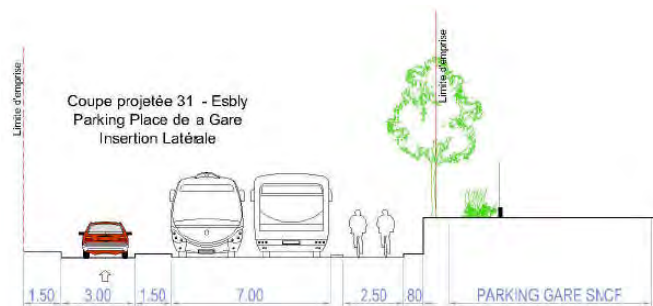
Coupe projetée au nord de la voie ferrée Paris-Meaux, en amont de la rue Félix Faure – Source : SYSTRA
